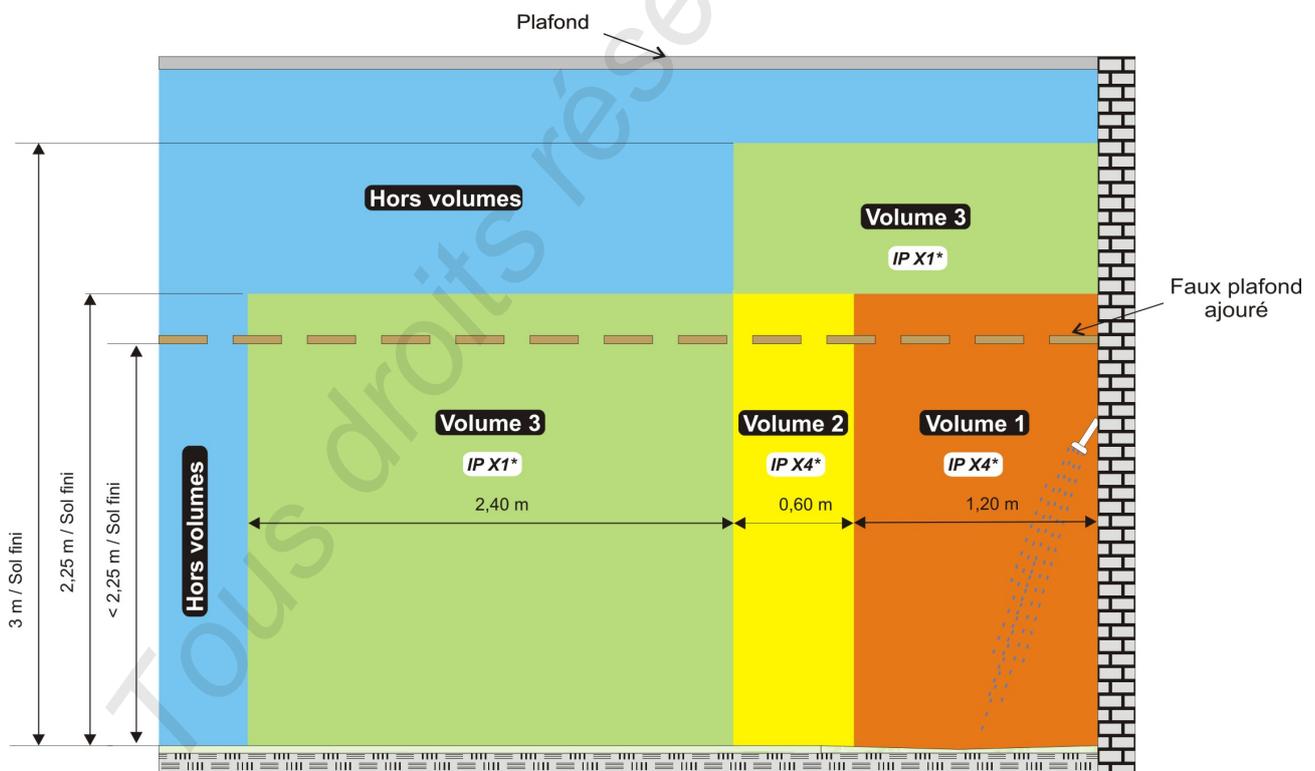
U – Faux plafond ajouré situé à moins de 2,25 m du fond du receveur ou de la baignoire
